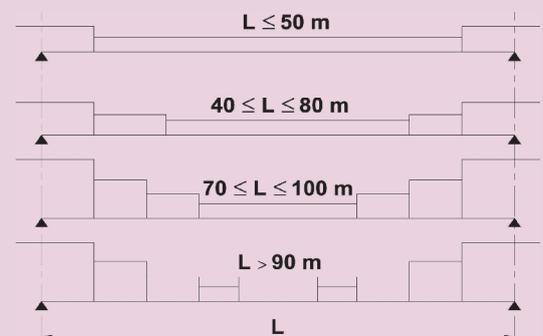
Nombre indicatif de changements d'épaisseur des semelles dans une travée intermédiaire d'un tablier de hauteur constante
